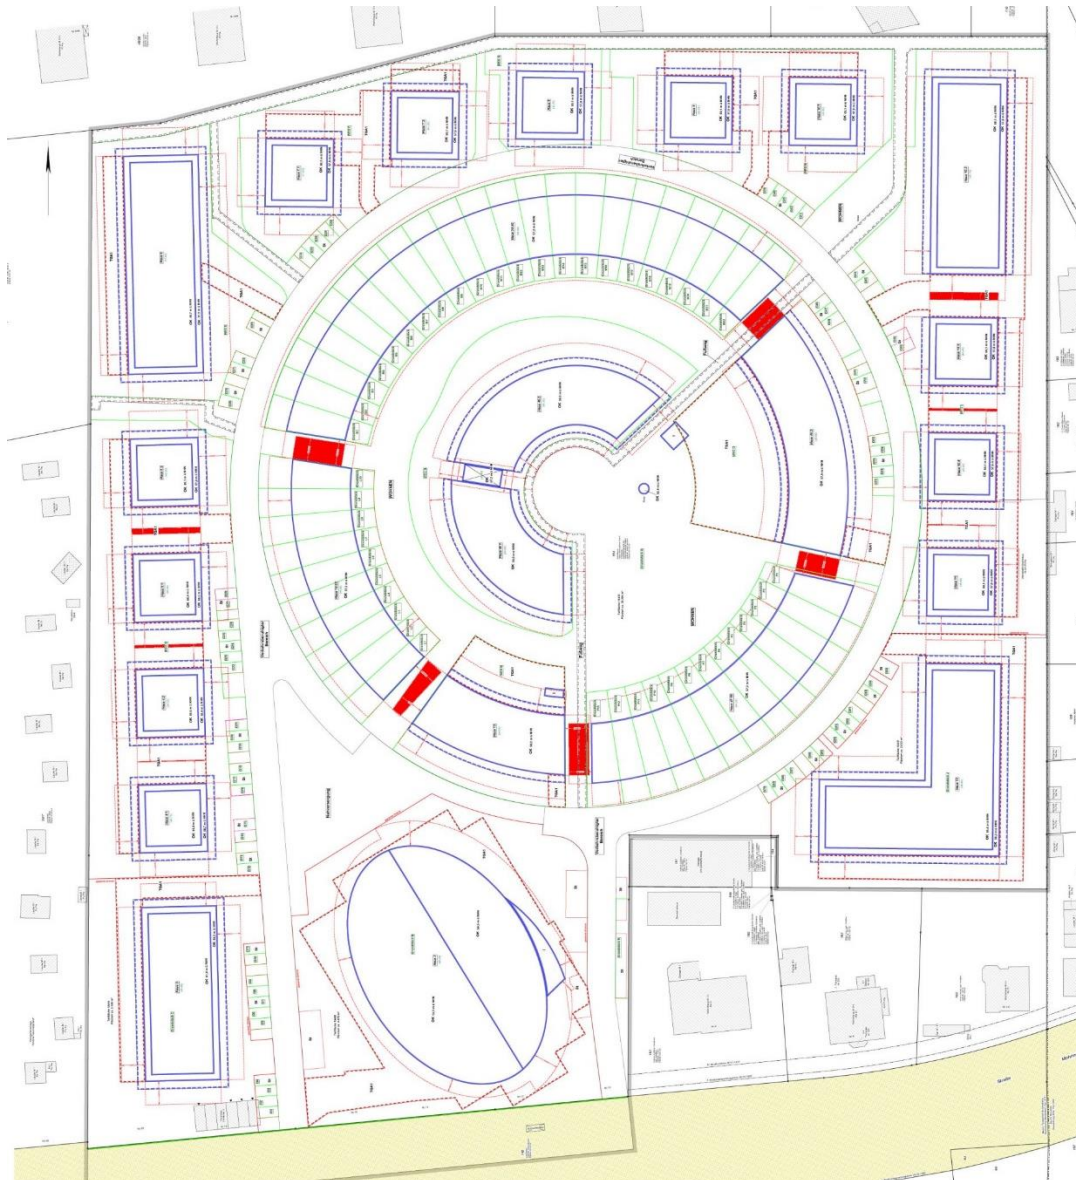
Darstellung der Bereiche mit Unterschreitung der Abstandsflächen (rote Flächen)
